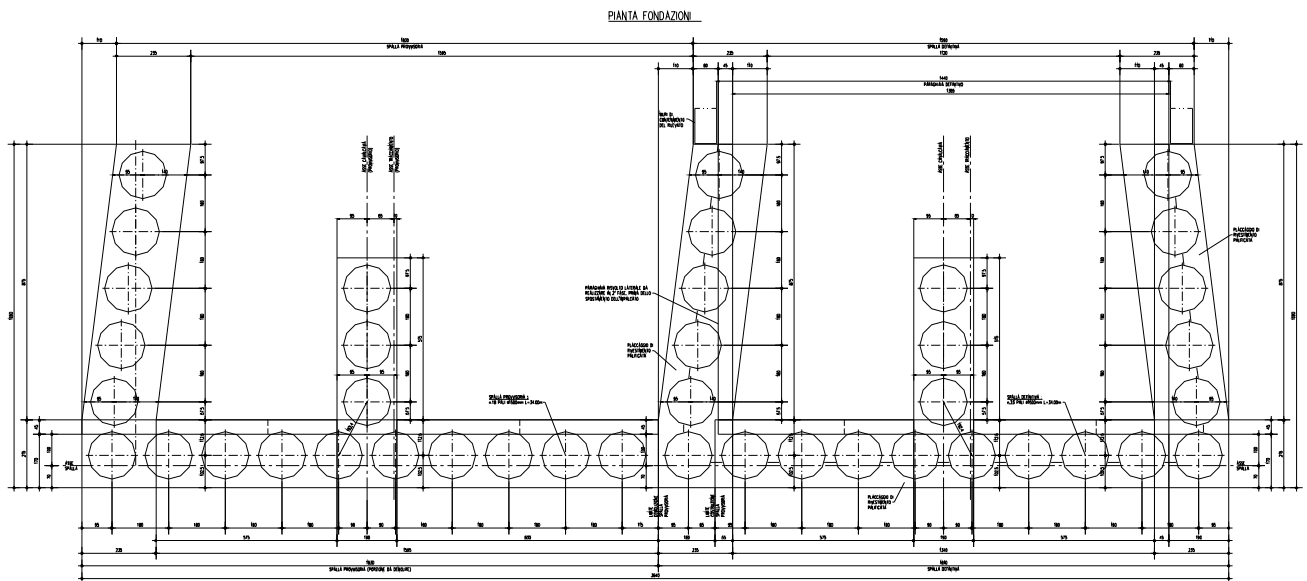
Pianta spalla provvisoria e definitiva
